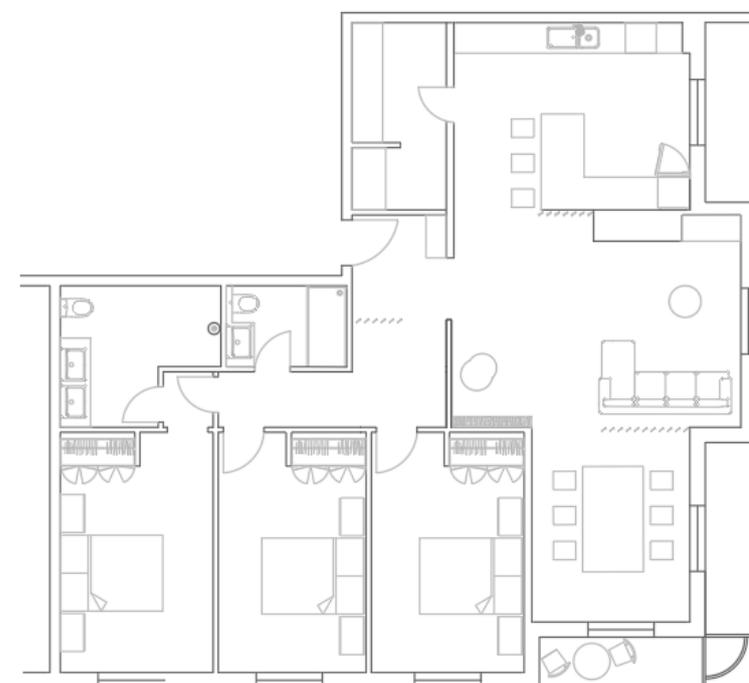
Esboço, planta 2d, *autocad*, André Bastos, 12\01\2023
